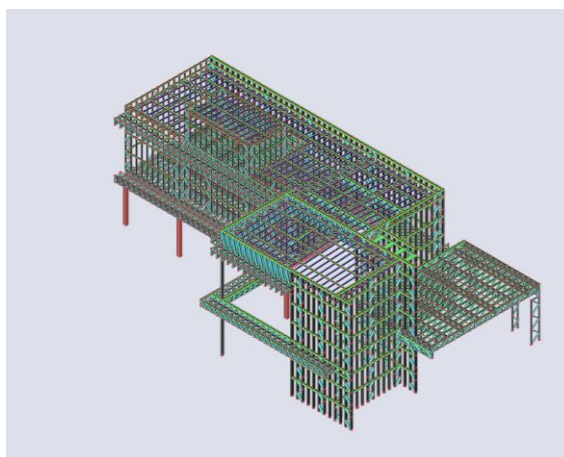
Modelagem tridimensional unifilar do pavimento superior
